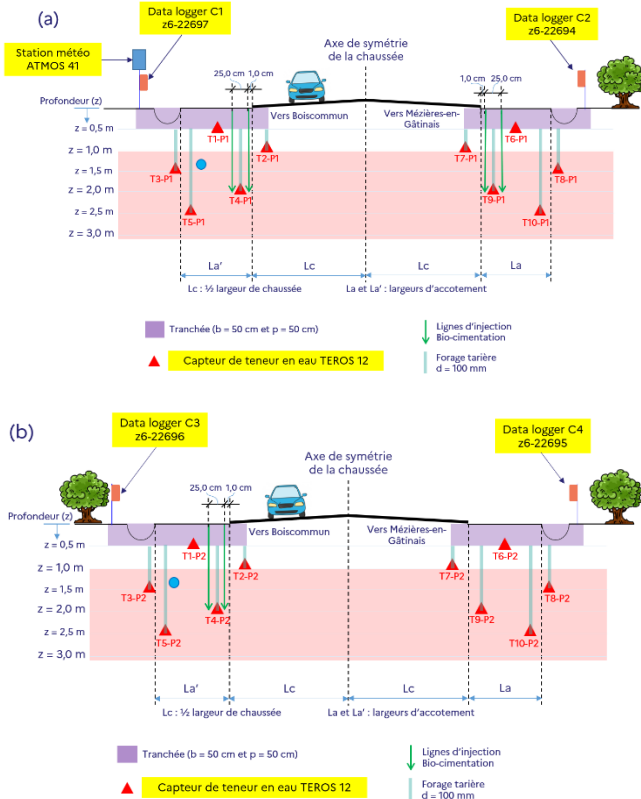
Schéma d'implantation de l'instrumentation au milieu de la planche PL1 (a) et de la planche PL2 (b)
